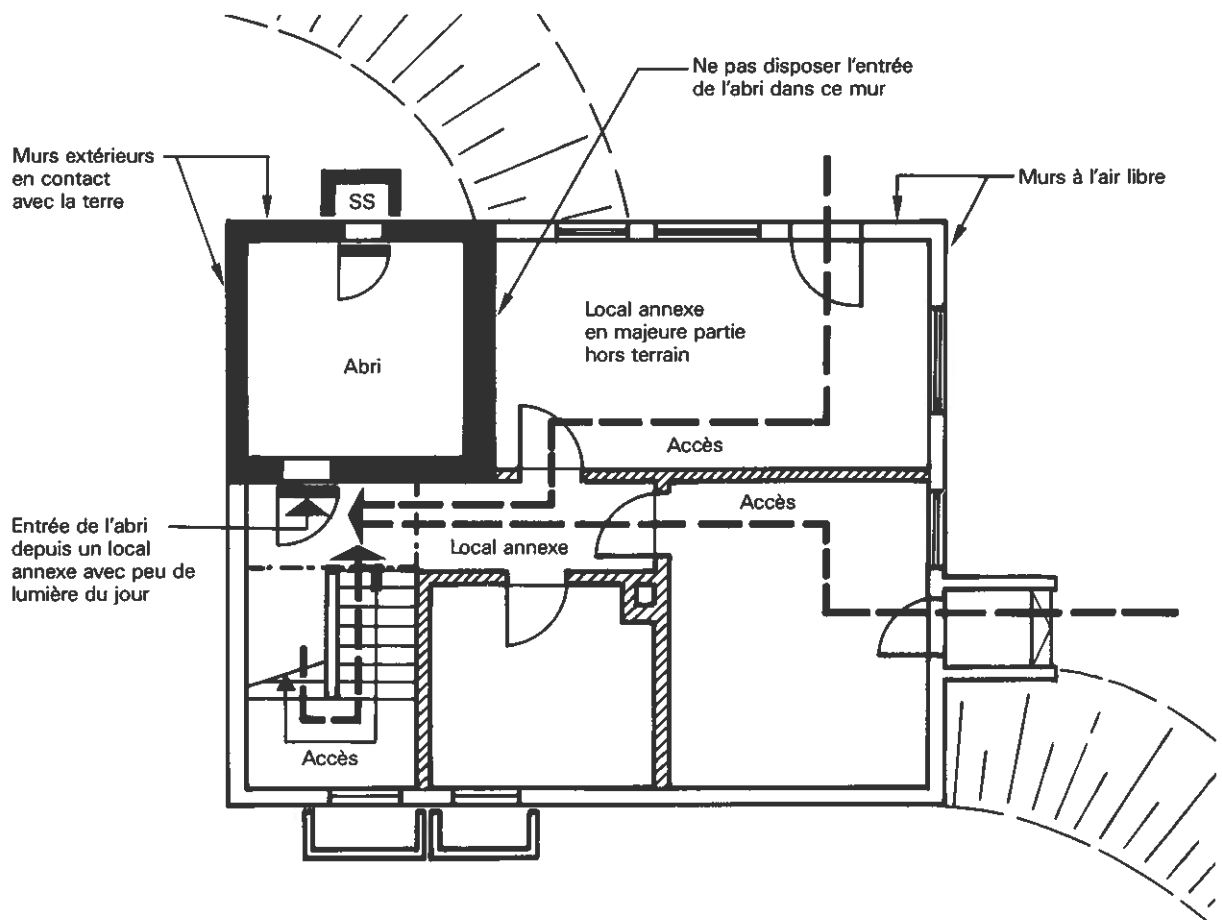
Disposition de l'entrée de l'abri (plan du sous-sol du bâtiment)
